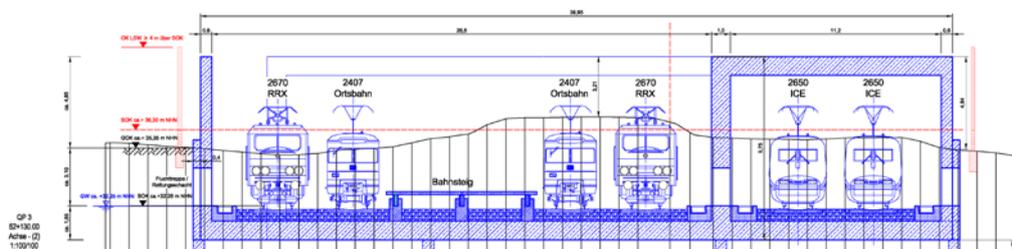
Variante „Einhausung“, Haltepunkt Angermund, Querschnitt [1]
